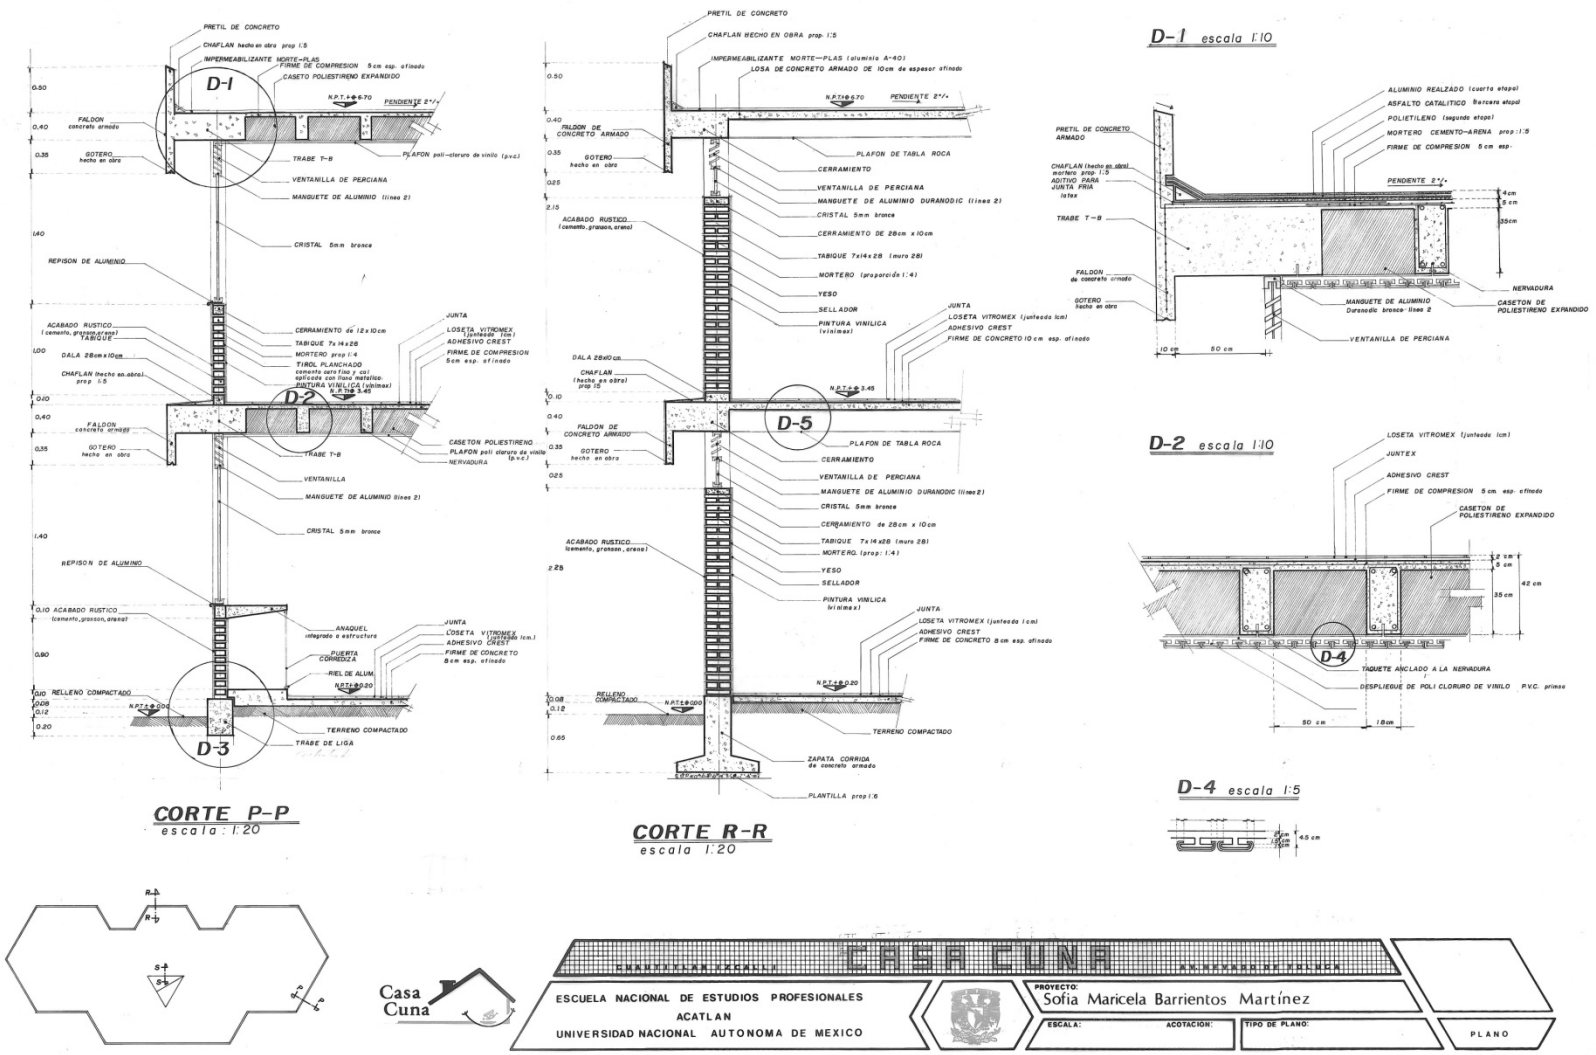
Plano de detalles constructivos, cortes por fachada (elaborado a mano)
